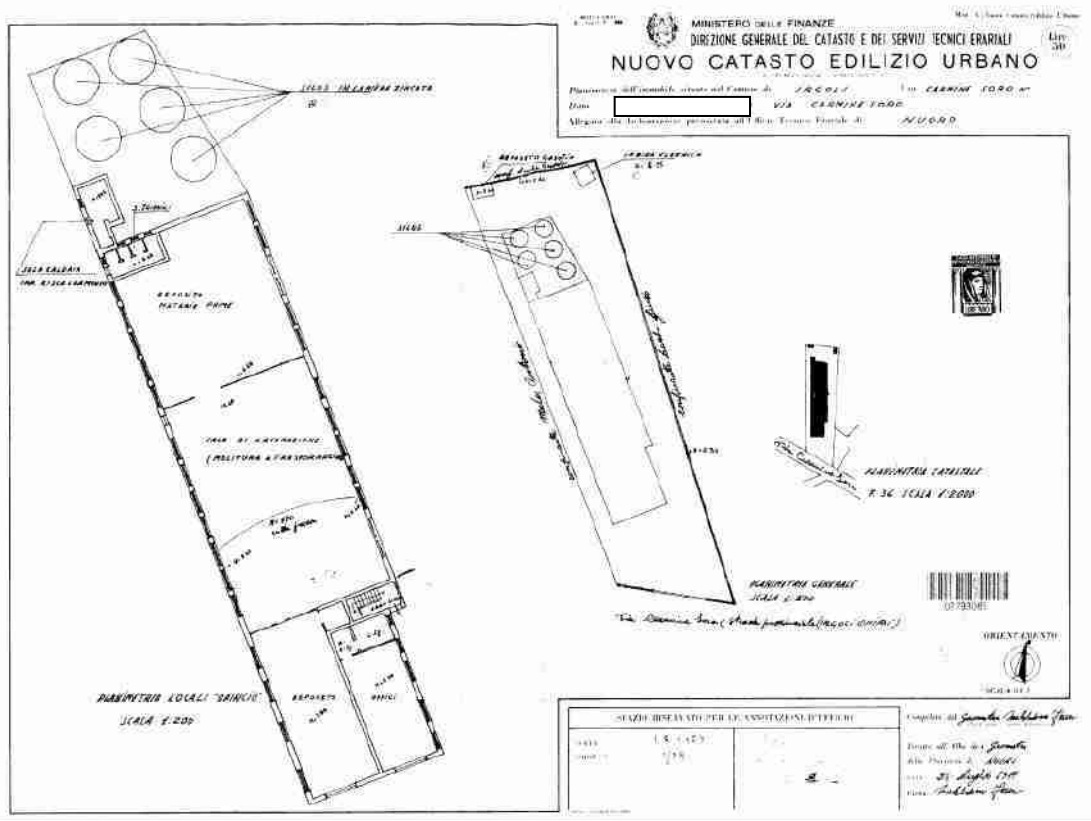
\_planimetria catastale del f.36 p.la 2506 sub.1
